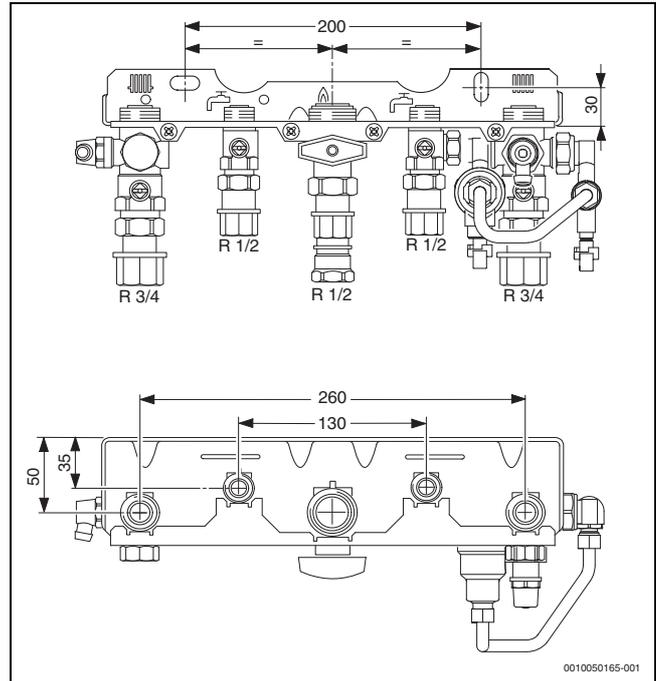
Beispiel: Montageanschlussplatte Nr. 1660 mit Füllleinrichtung
